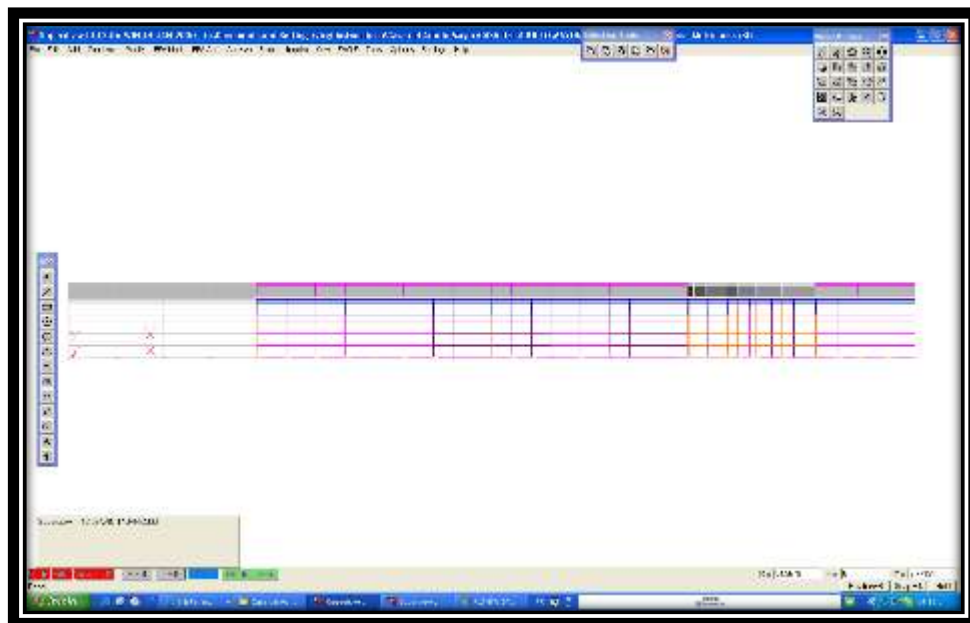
, Vista Lateral de la Edificación. Plano XZ.
